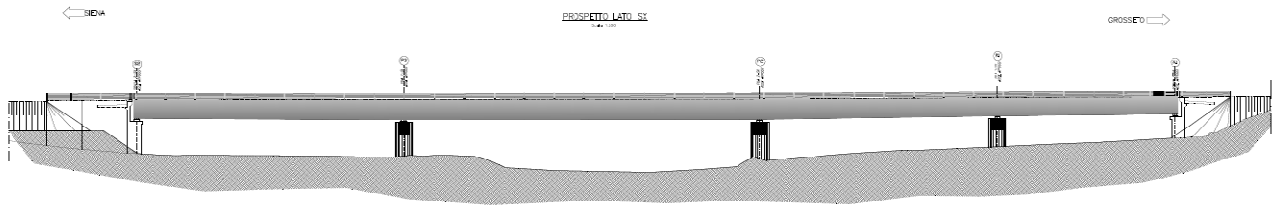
Prospetto viadotto sul fiume Imerse
